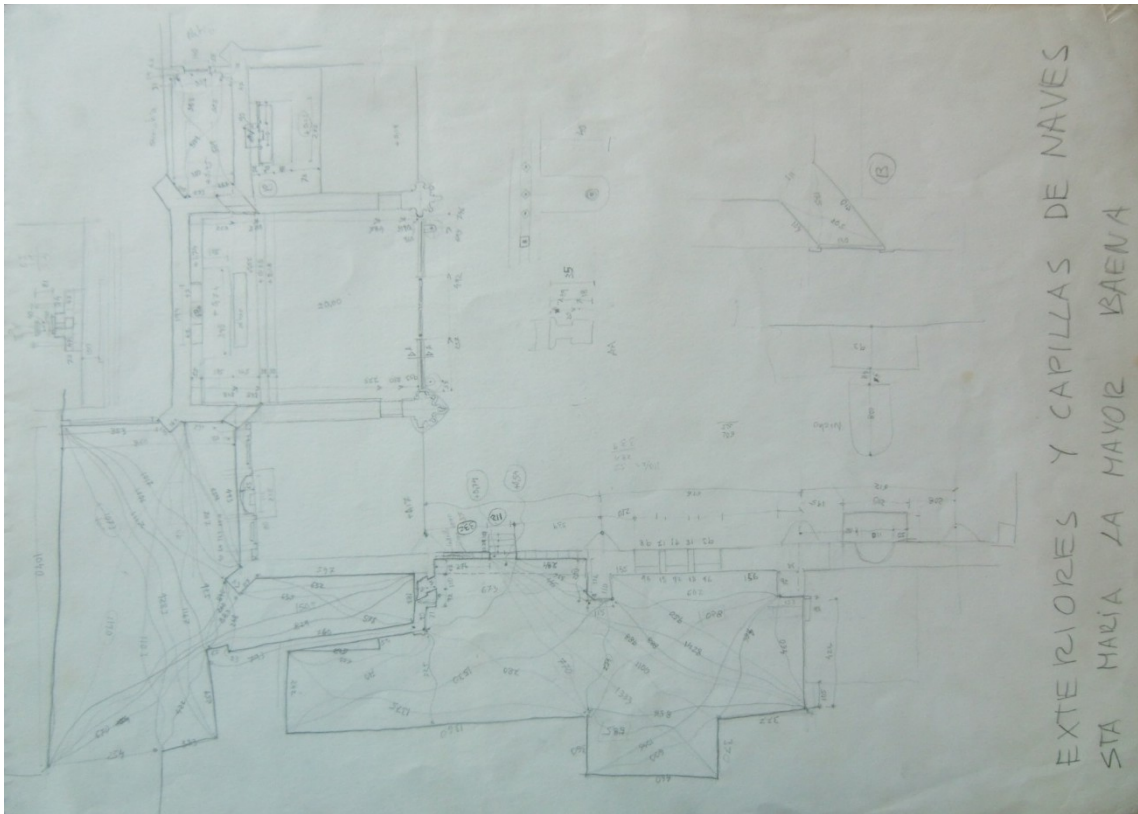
Planta y Exteriores - Croquis del levantamiento realizado por el autor
